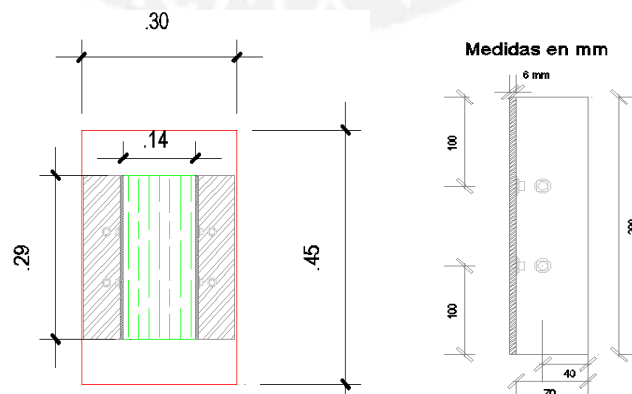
Conexión columna C-6 y Zapata Z-1
